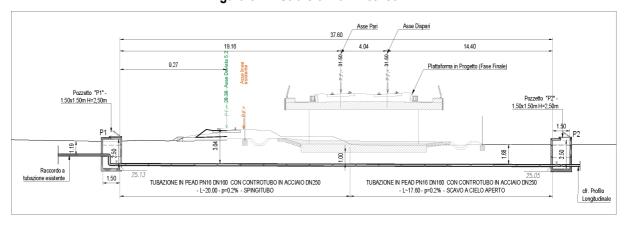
Attraversamento pk 24+062,000 – Sezione Longitudinale
